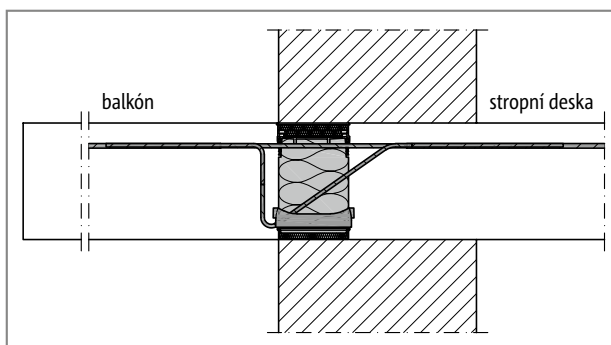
Schöck Isokorb® XT typ KL: Balkón na zalomené fasádě (částečně zapuštěný)
